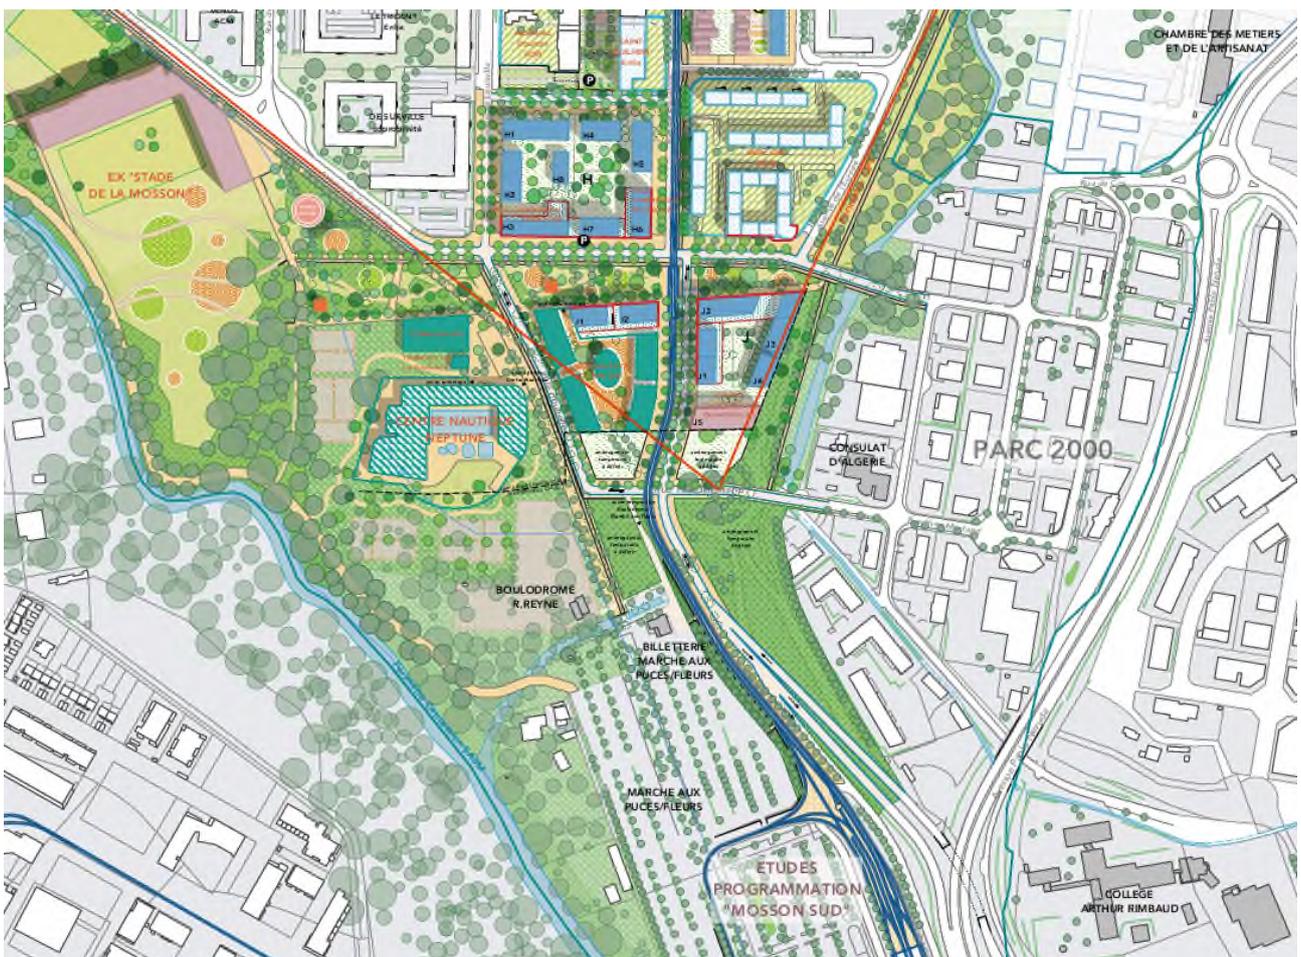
PLAN MASSE FUTUR MOSSON SUD
